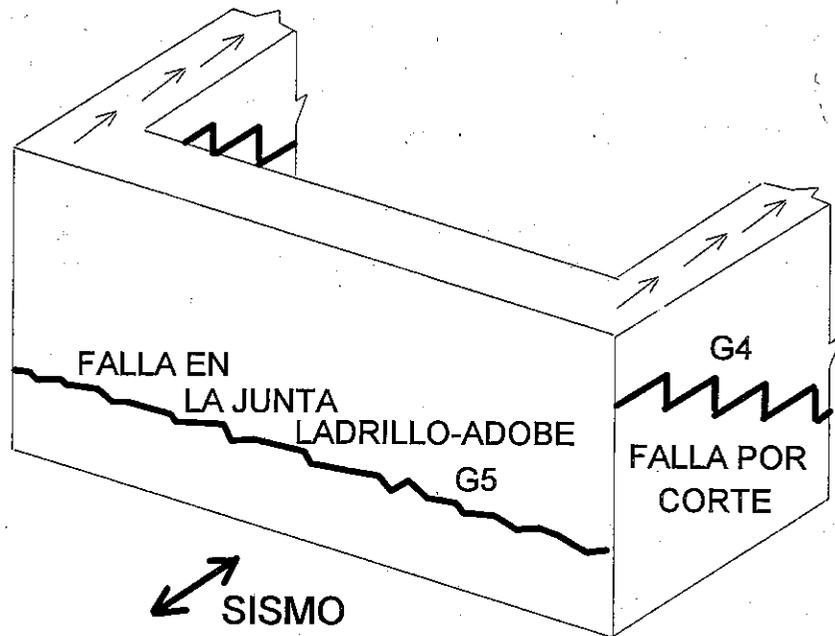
OTRAS FALLAS EN LOS MUROS DE ADOBE
